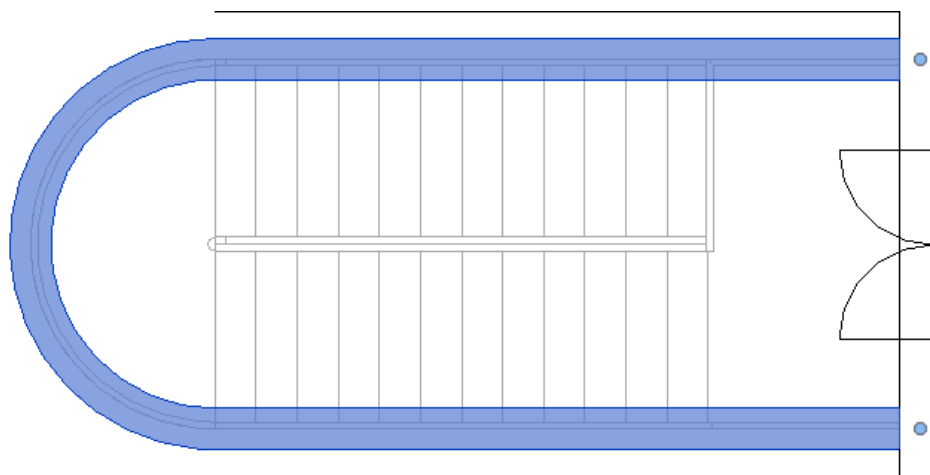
Dibujo de muro que contendrá la estructura metálica
